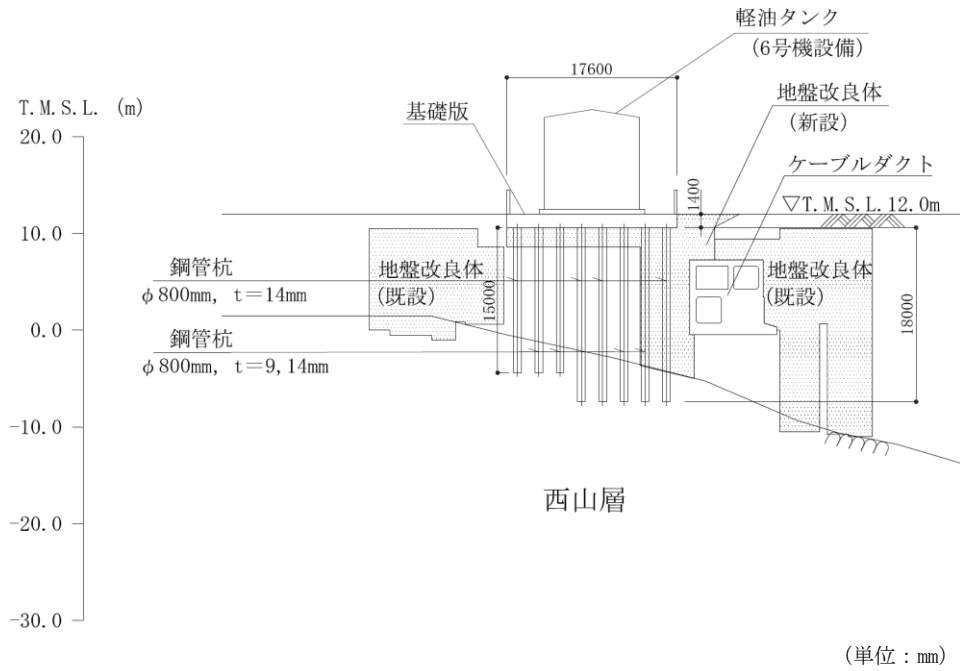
軽油タンク基礎 (6号機設備) 断面図 (A-A断面)
